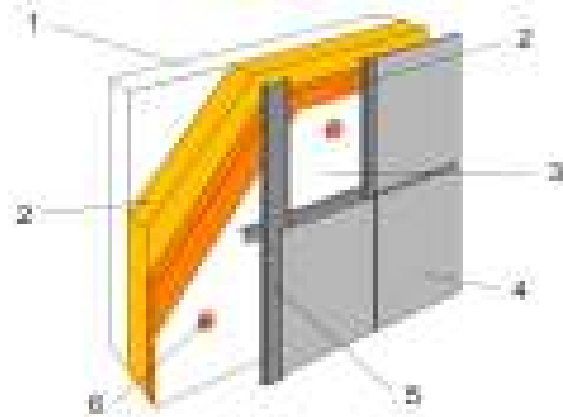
Утепление стены по технологии «вентилируемый фасад»: 1 – стена; 2 – утеплитель; 3 – влаго-ветрозащитная мембрана; 4 – облицовочная плитка; 5 – металлопрофиль; 6 – крепеж для утеплителя.
